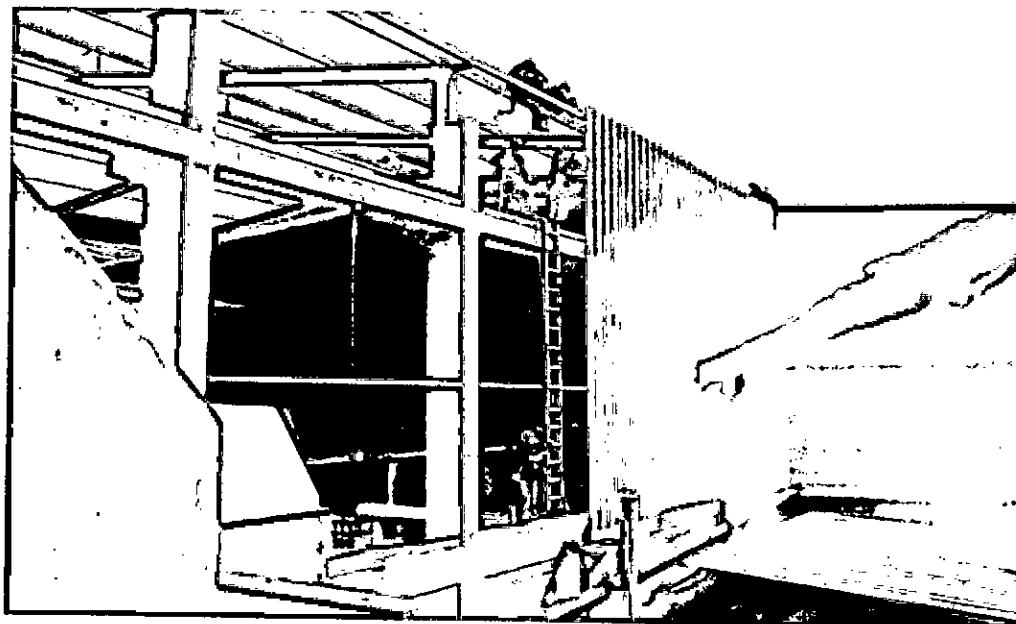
Montaje de estructura metálica de Pared.
